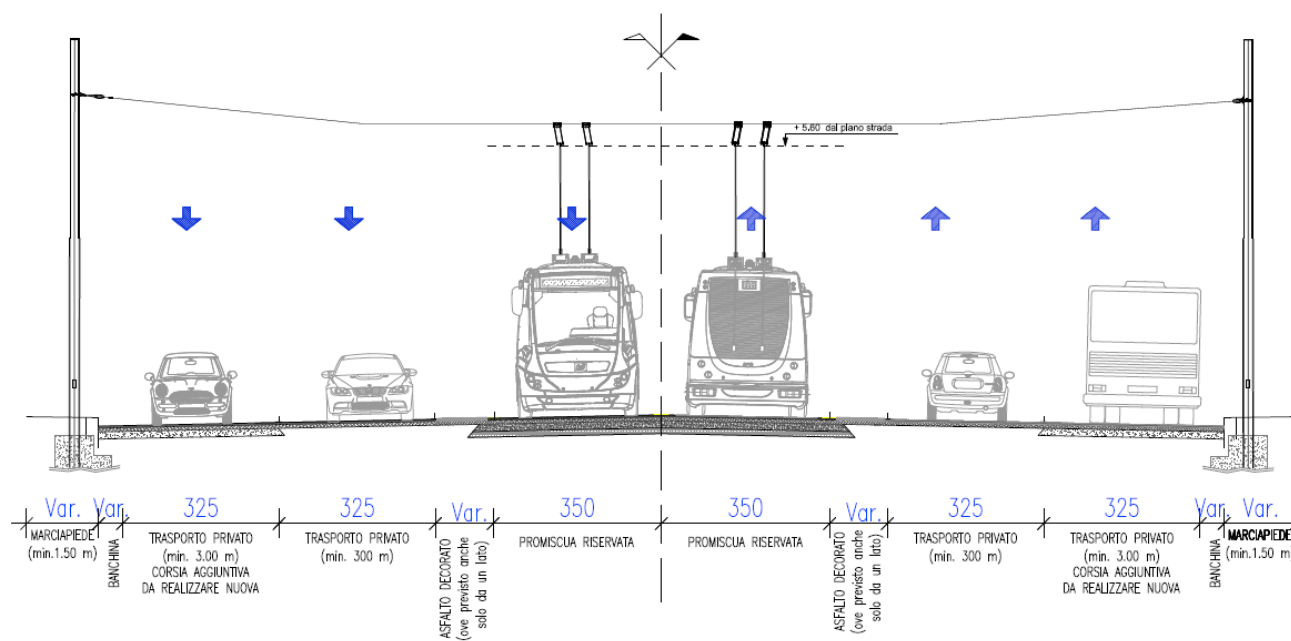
Sezione tipo E1 applicata sull'asse Lavoro - Nazioni
